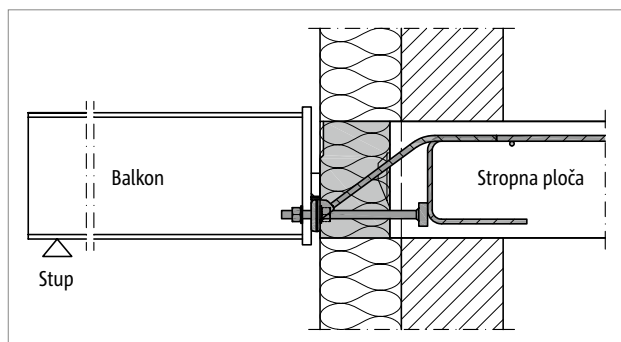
Schöck Isokorb® XT tip SQP-WU: posebna konstrukcija; potrebna kod priključka na armiranobetonski zid
